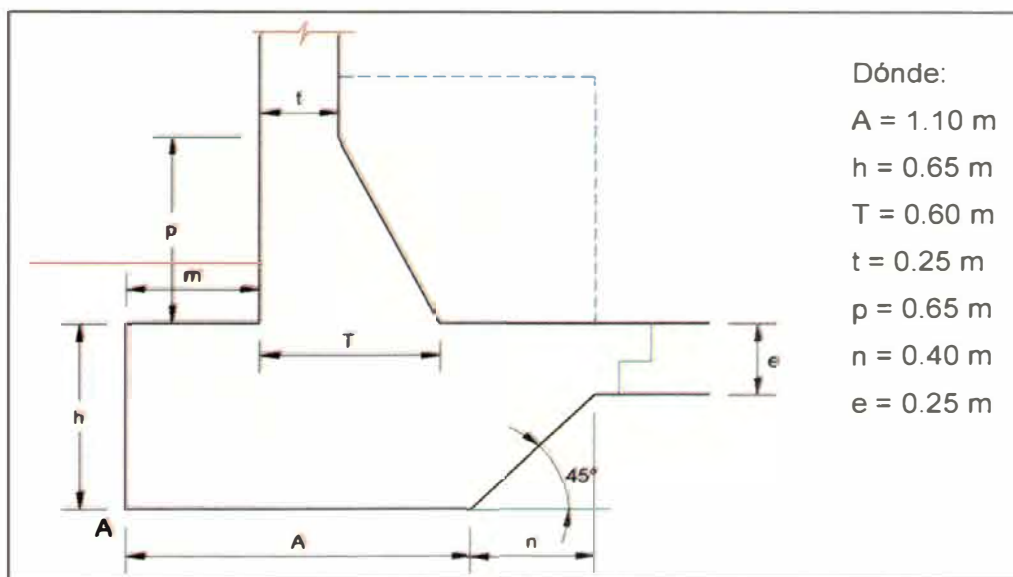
Dimensiones de la cimentación propuesta.
